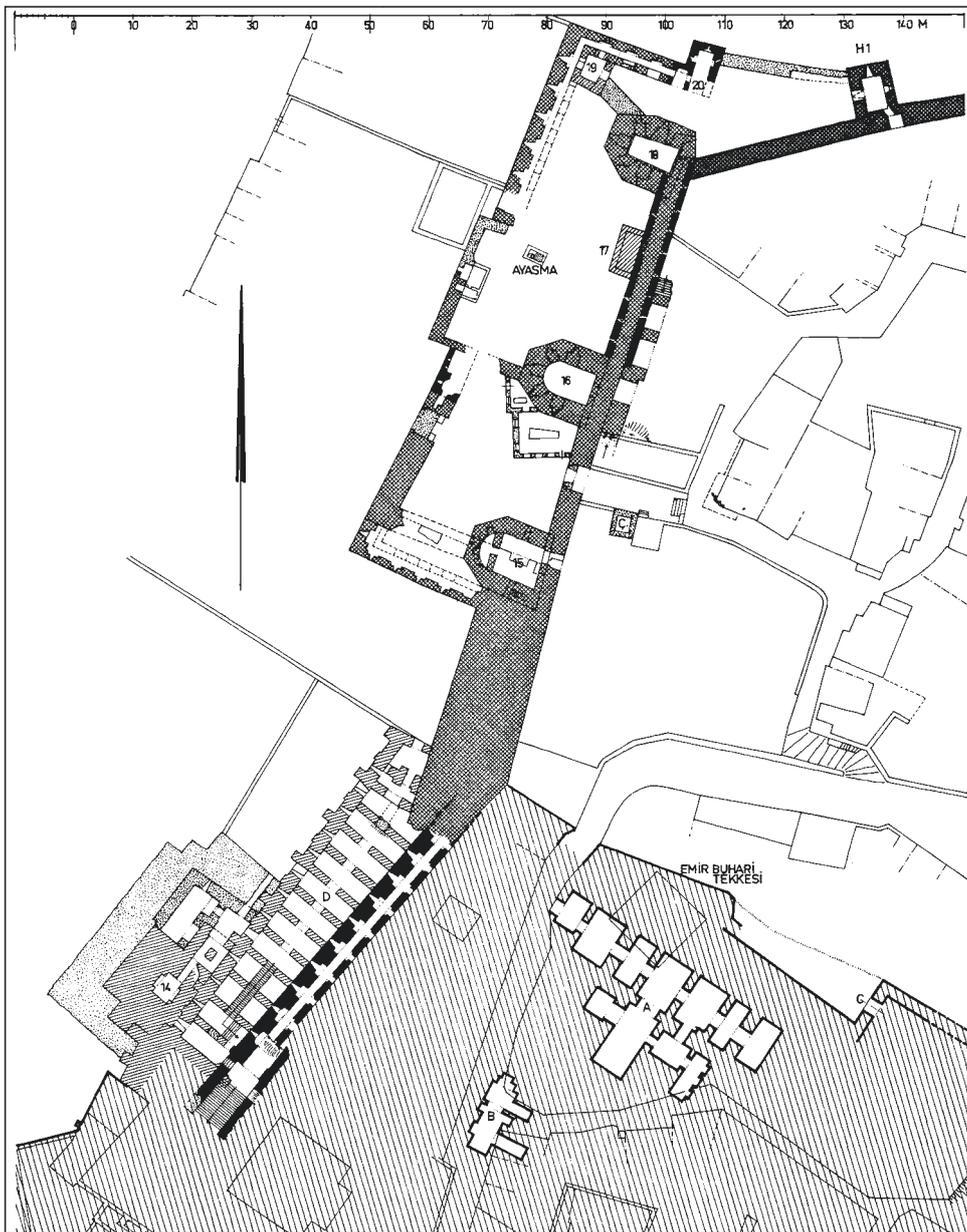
Lageplan der Blachernenmauer. – (Nach Müller-Wiener, Topographie 304 Abb. 349).
